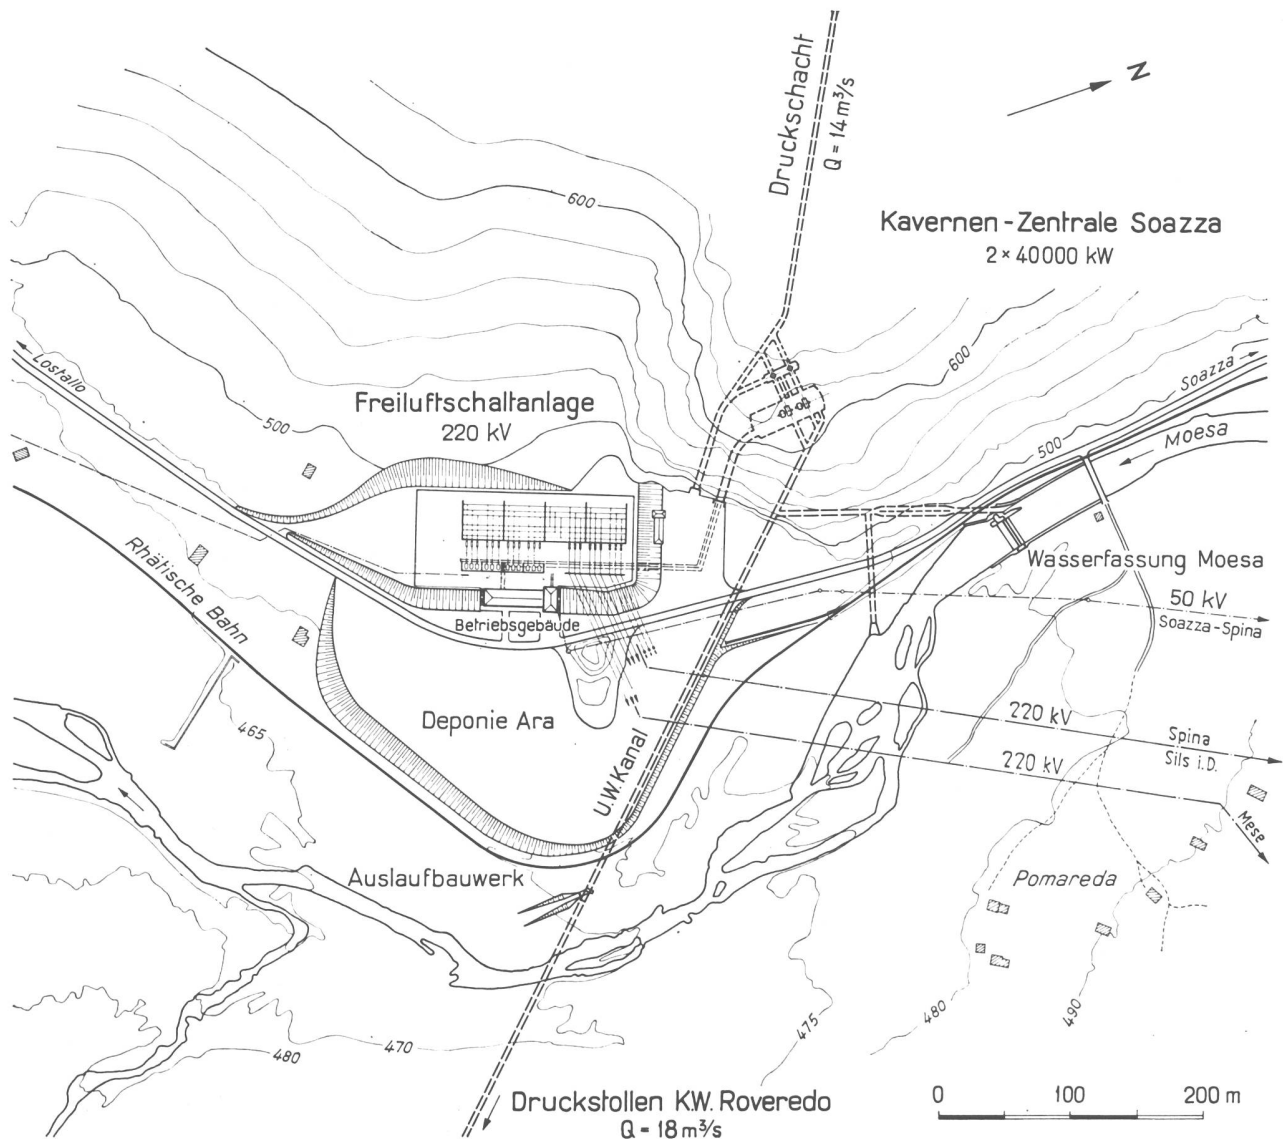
Lageplan der Anlagen in Ara mit Kavernenzentrale Soazza, 220-kV-Freiluftschaltanlage und Betriebsgebäude
